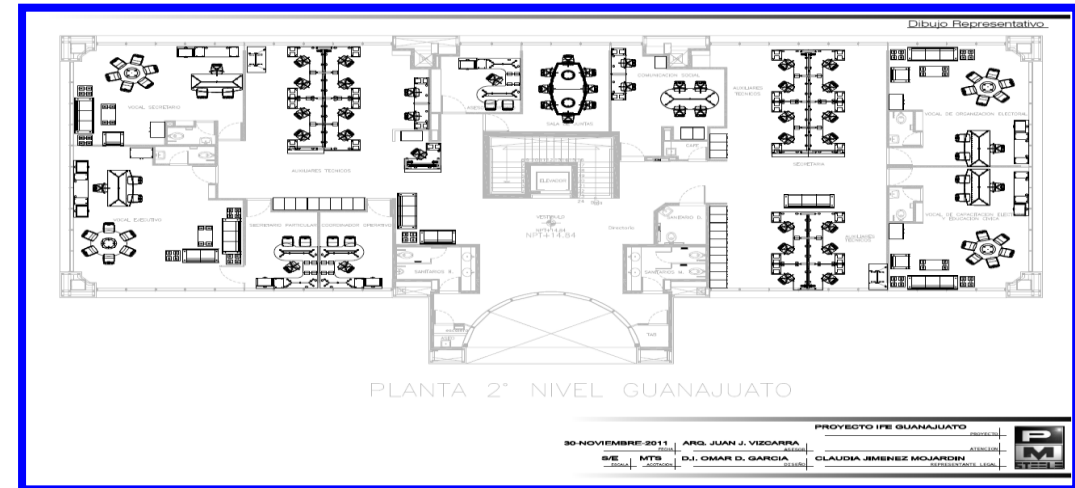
Planos Sembrados del proyecto Juntas Locales del IFE vista en planta
